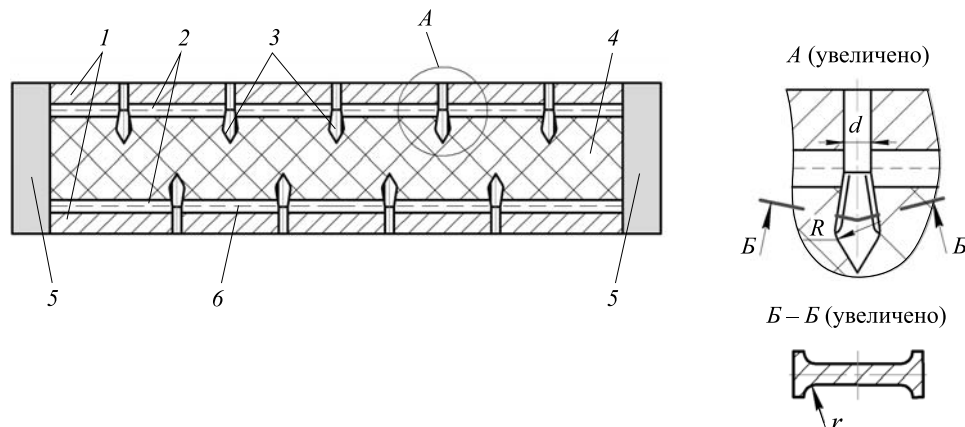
Универсальный конструктивный элемент для управления собственным НДС: 1 — металлическая пластина; 2 — пластиковая трубка, в которой находится металлическая или композитная нить; 3 — копьсообразный цилиндрический штифт (крепежный элемент); 4 — плита из полимерного композиционного материала; 5 — установочно-регулирующий замок (управляющее устройство — актуатор); 6 — нить, условно обозначенная штриховой линией
